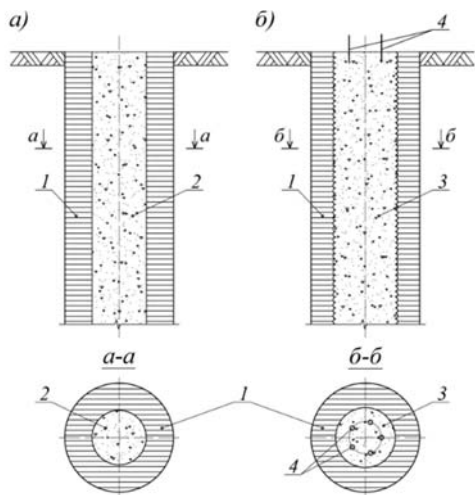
Схема устройства грунтобетонной сваи (ГБС)
